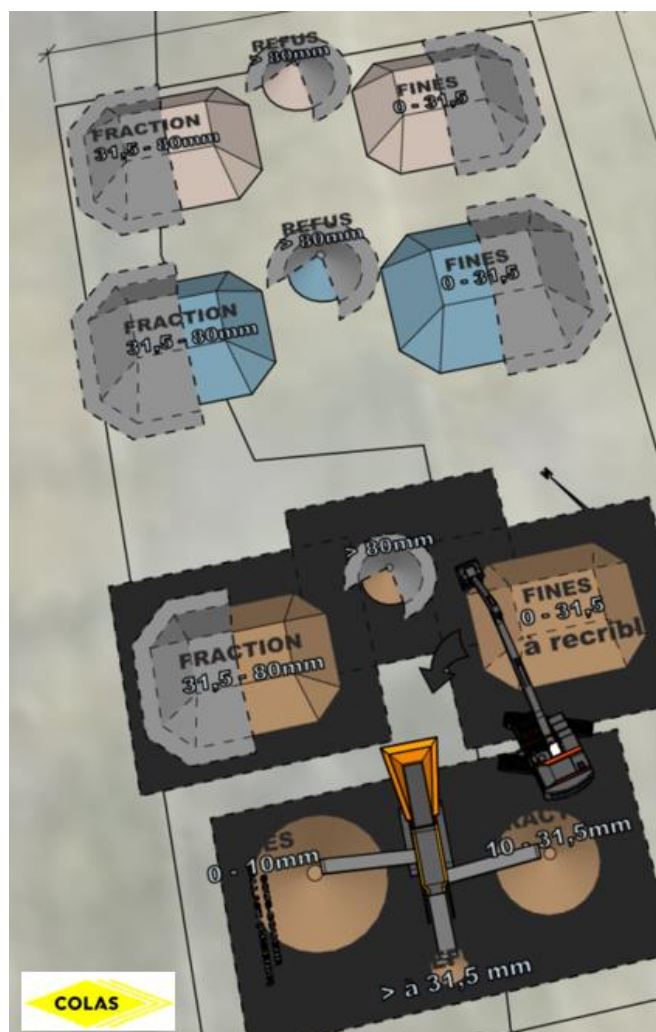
Vue de la zone de criblage en fin de travaux (source : phasage EXE, COLAS)
